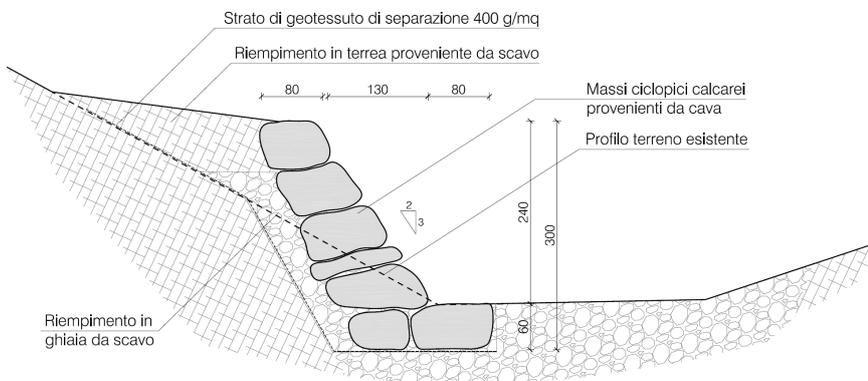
Protezione radente in massi ciclopici: sezione tipo di progetto
